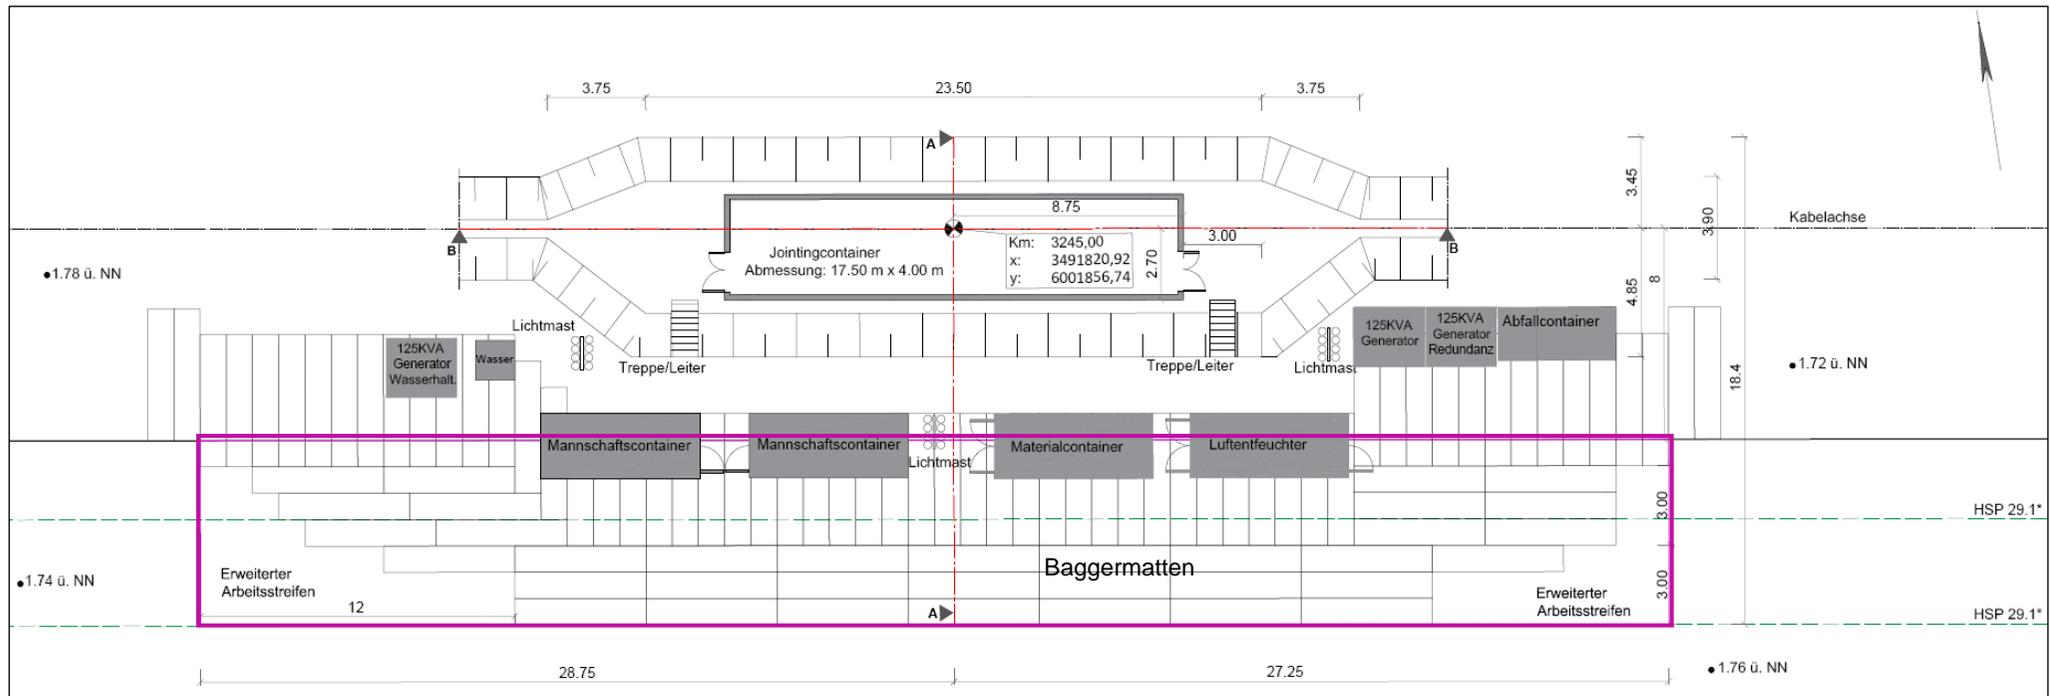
Prinzipskizze – Baustelleneinrichtung und Baugrube für Kabelmuffen im Grundriss
